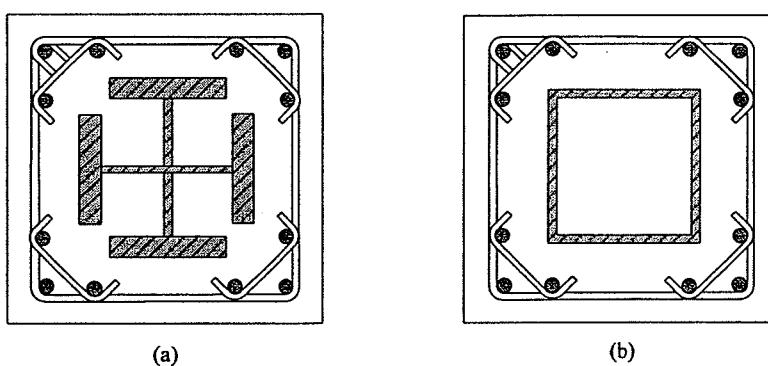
SRC 柱之主筋配置示意圖 [6]
